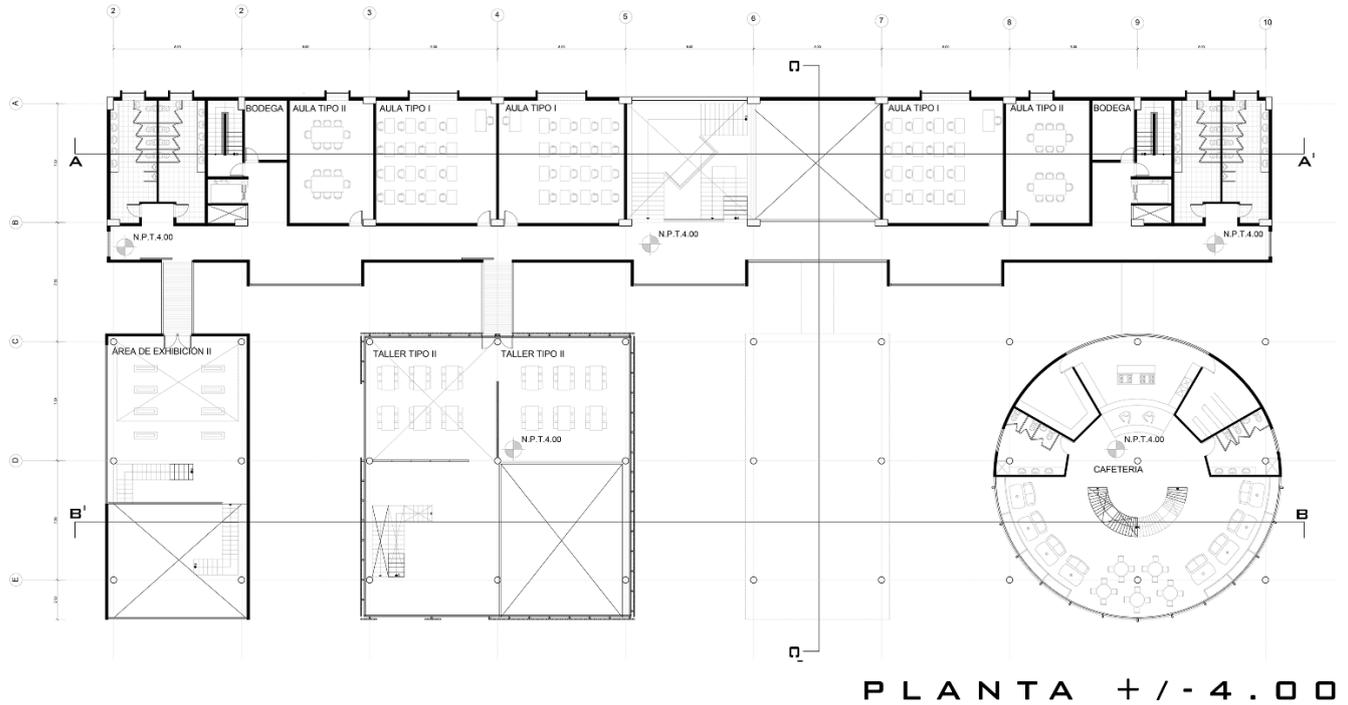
Segunda planta N+/-4.00 sin escala. Elaboración propia.
